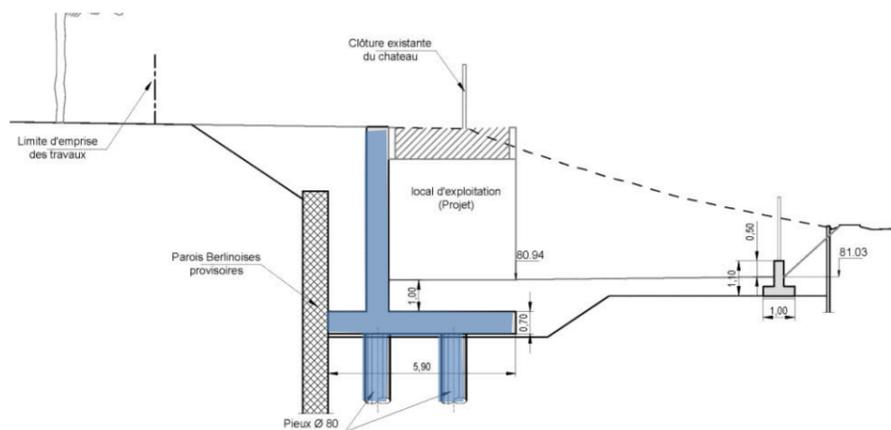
Coupe transversale du mur du local (Source : AVP- juillet 2015)
